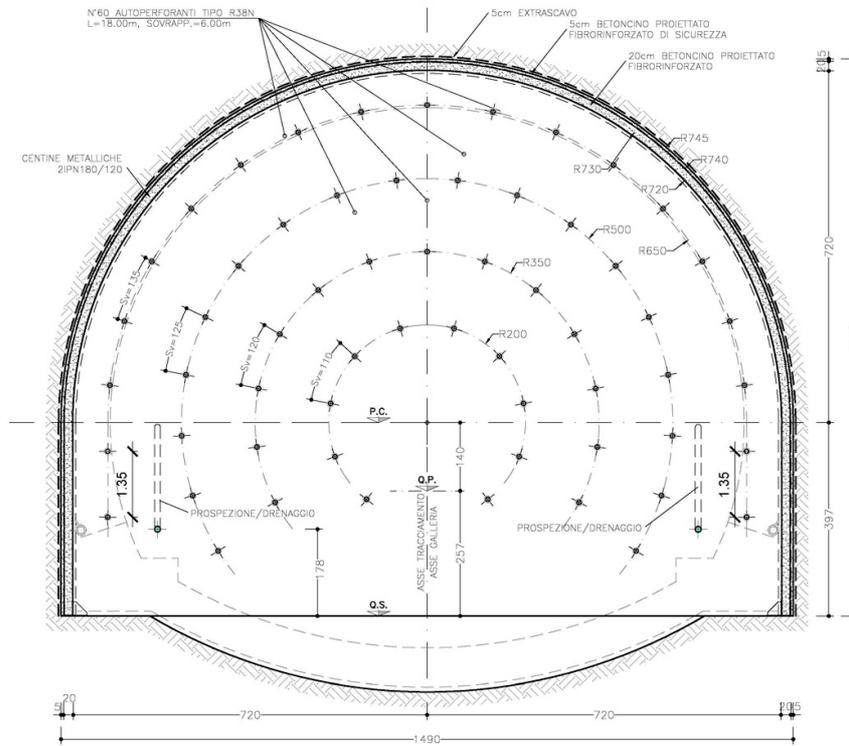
Sezione GN-B1 – Sezione di scavo.
